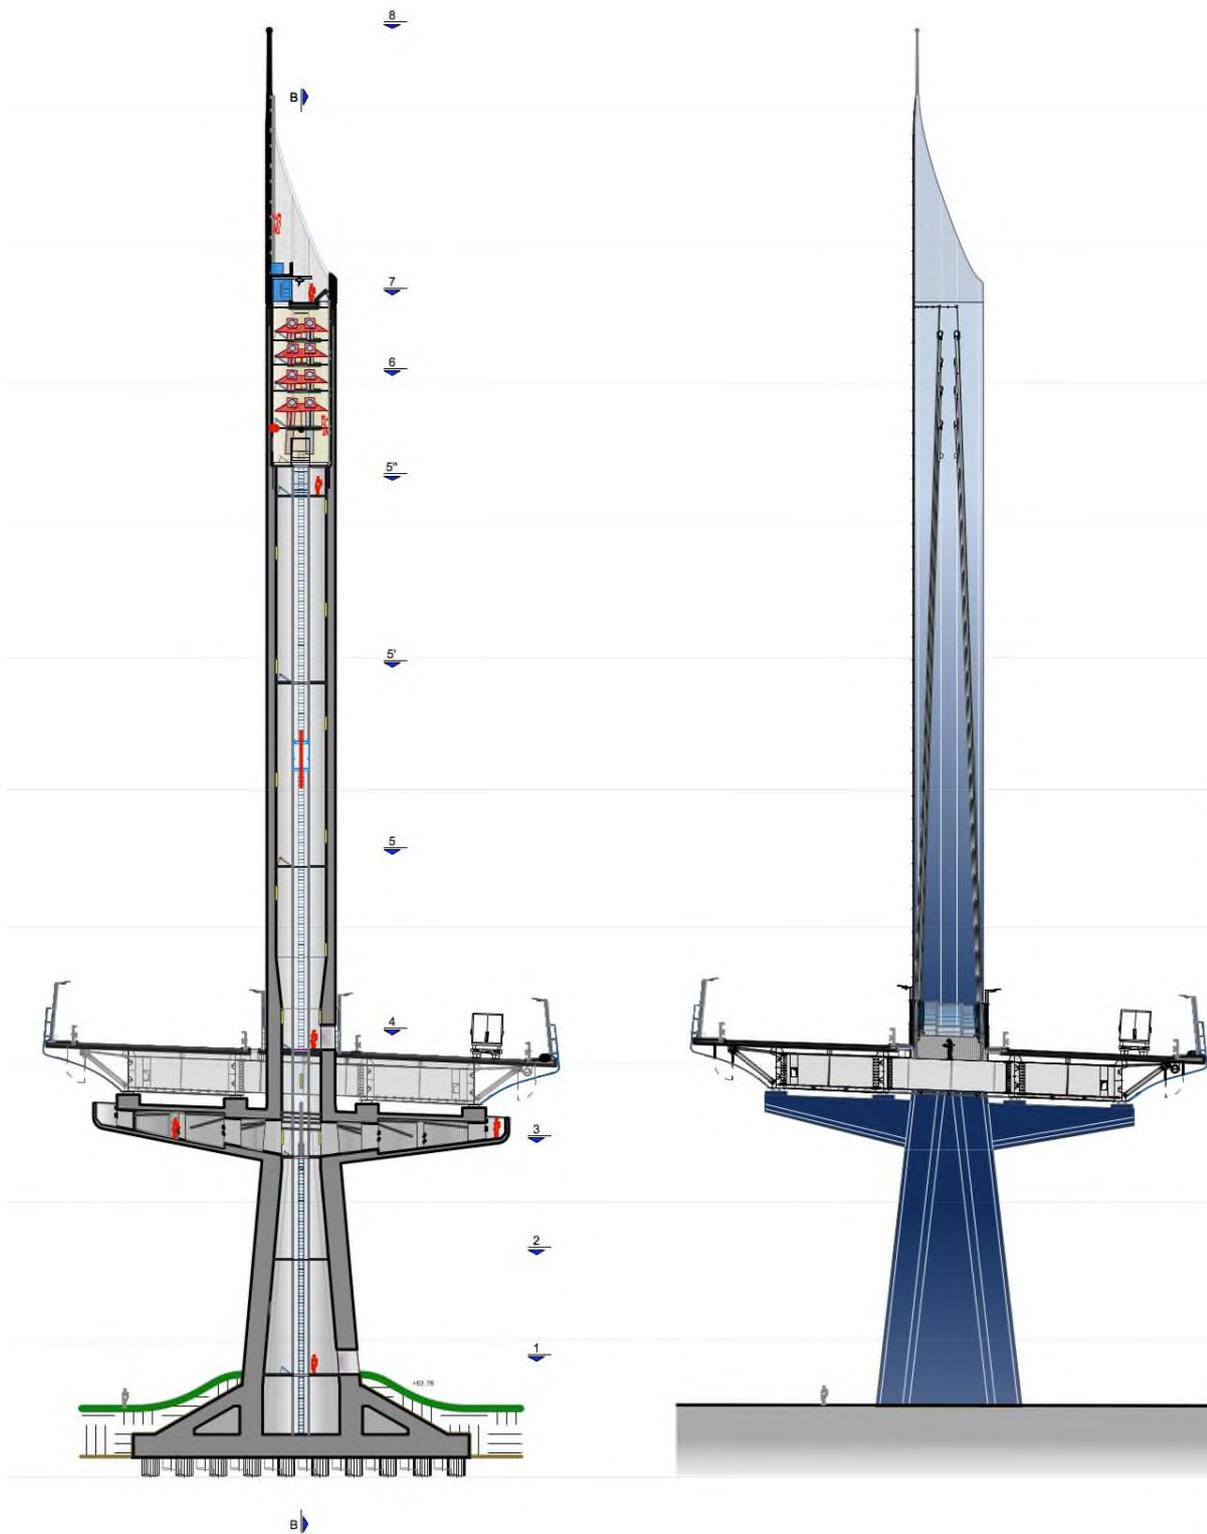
Pila – Sezione e Prospetto trasversali alla carreggiata.
